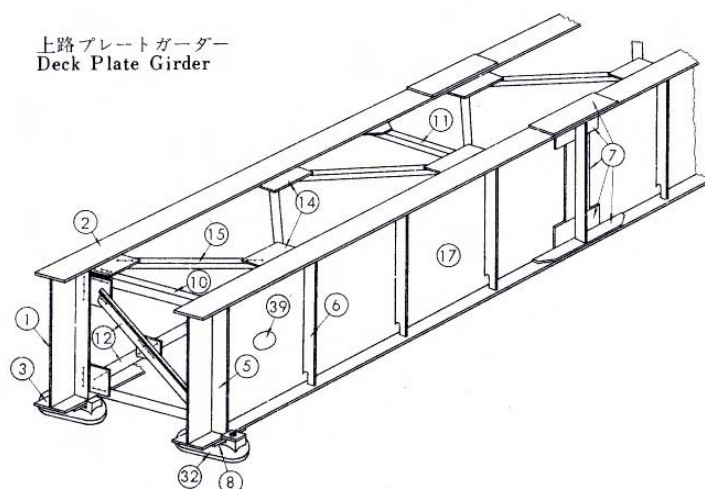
鉄道橋で使う上路プレートガーダーの構成図
